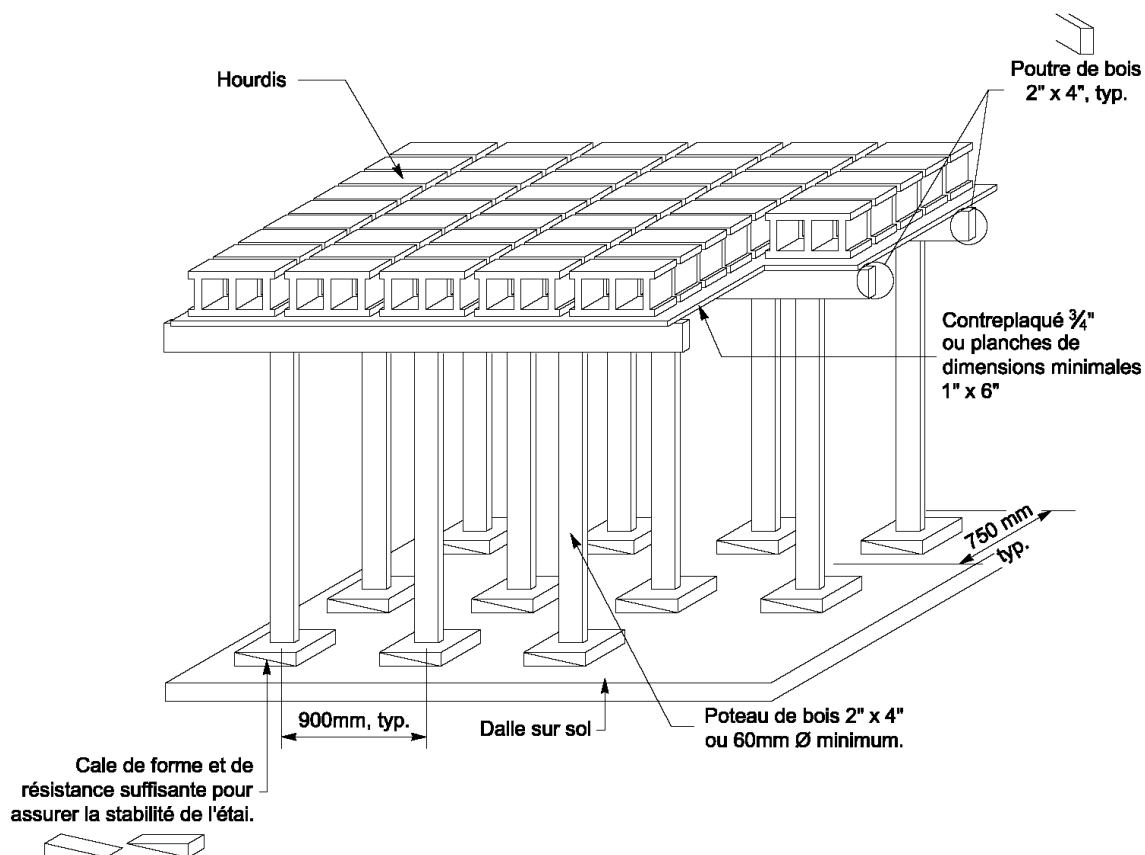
Étaie et coffrage de la dalle
